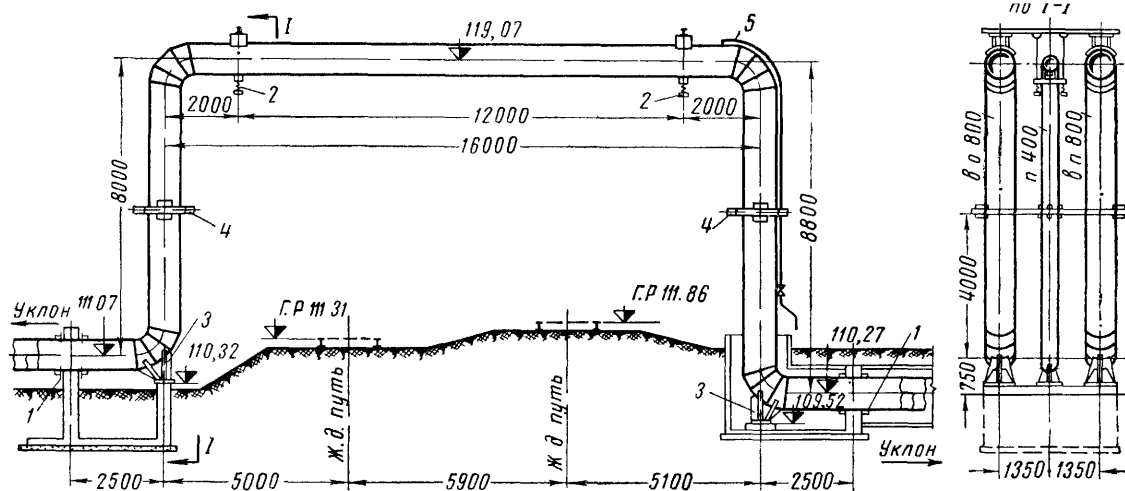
Пересечение железнодорожных путей теплопроводами без применения специальных высоких опор
